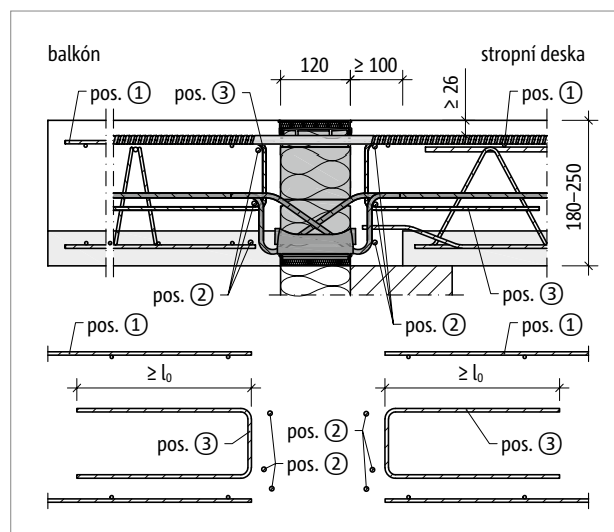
Schöck Isokorb® CXT typ KL-F: Nápojavací stavební výztuž u balkónové desky tloušťky $h = 180\text{--}250\text{ mm}$
